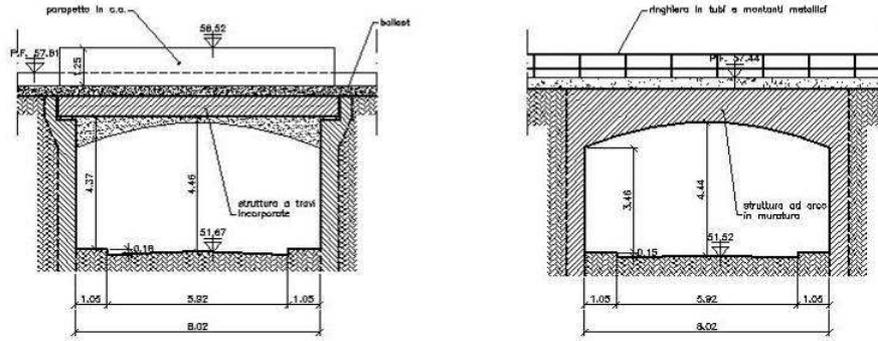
Sezioni longitudinale e trasversali stato di fatto
